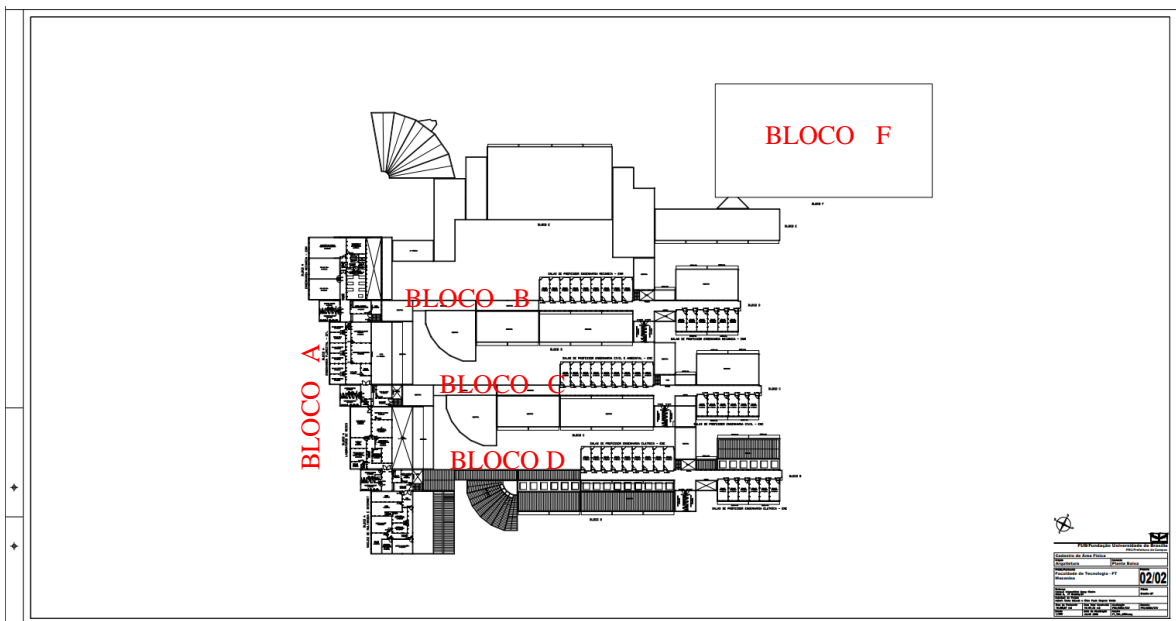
Planta baixa mezanino da Faculdade de Tecnologia
